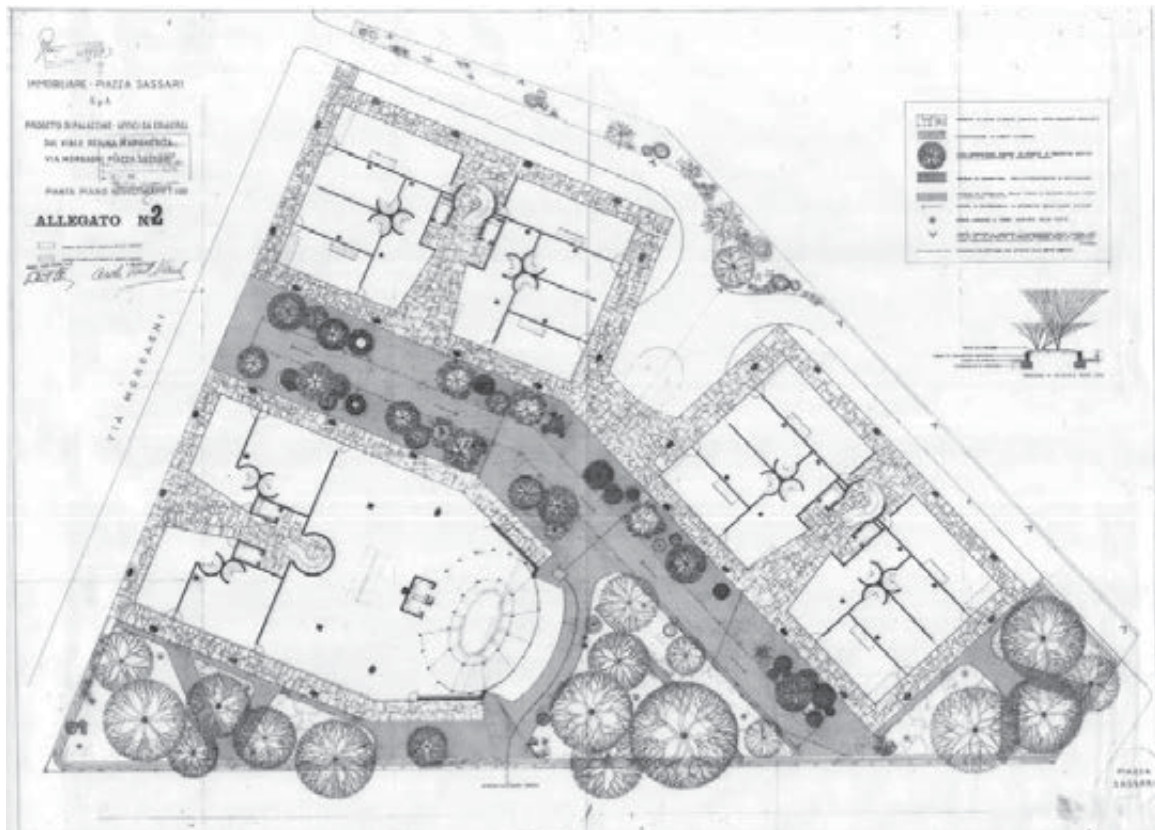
Pianta del piano terra destinato a negozi (CR, 1963)
